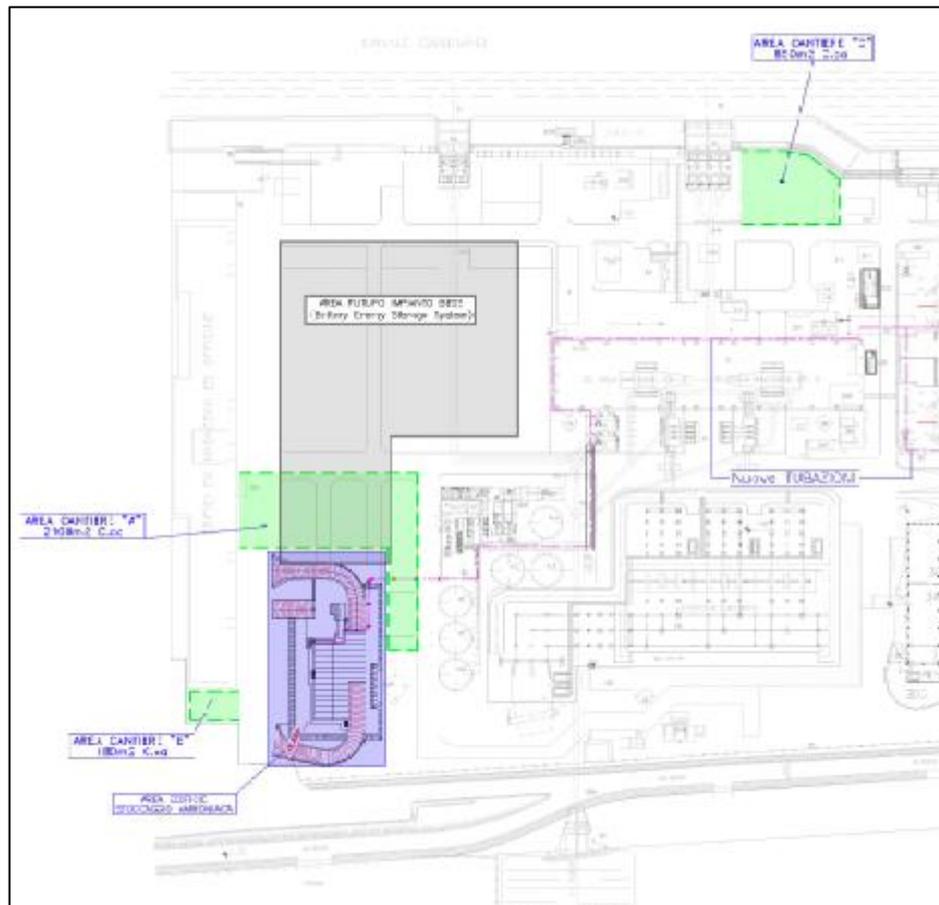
Progetto di upgrade impianto: aree di cantiere previste(verde) e area principale di intervento (viola)
